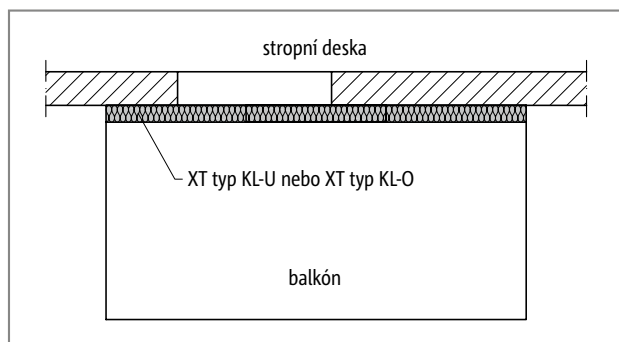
Schöck Isokorb® XT typ KL: Balkón s malým snížením oproti stropní desce
